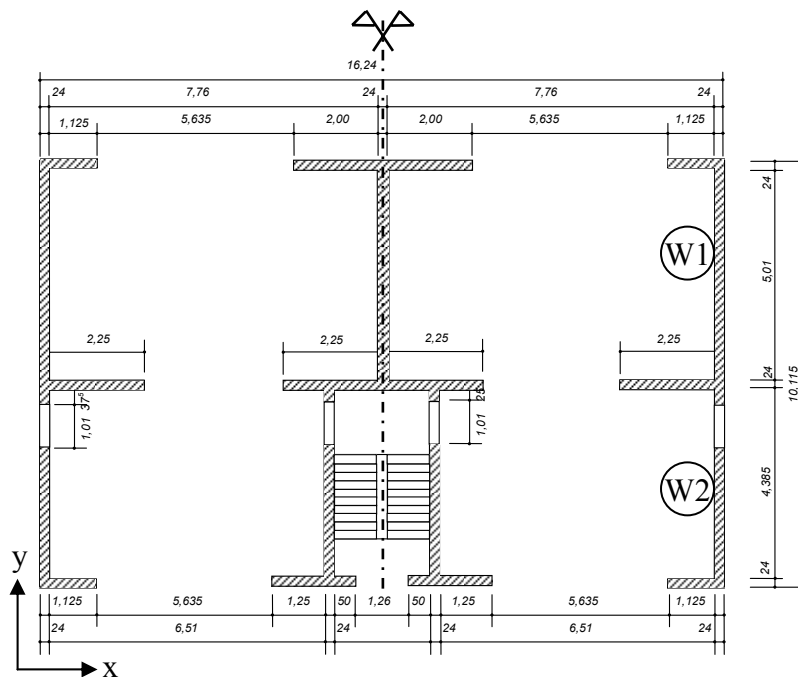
Grundriss eines 4-geschossigen Gebäudes aus Mauerwerk
